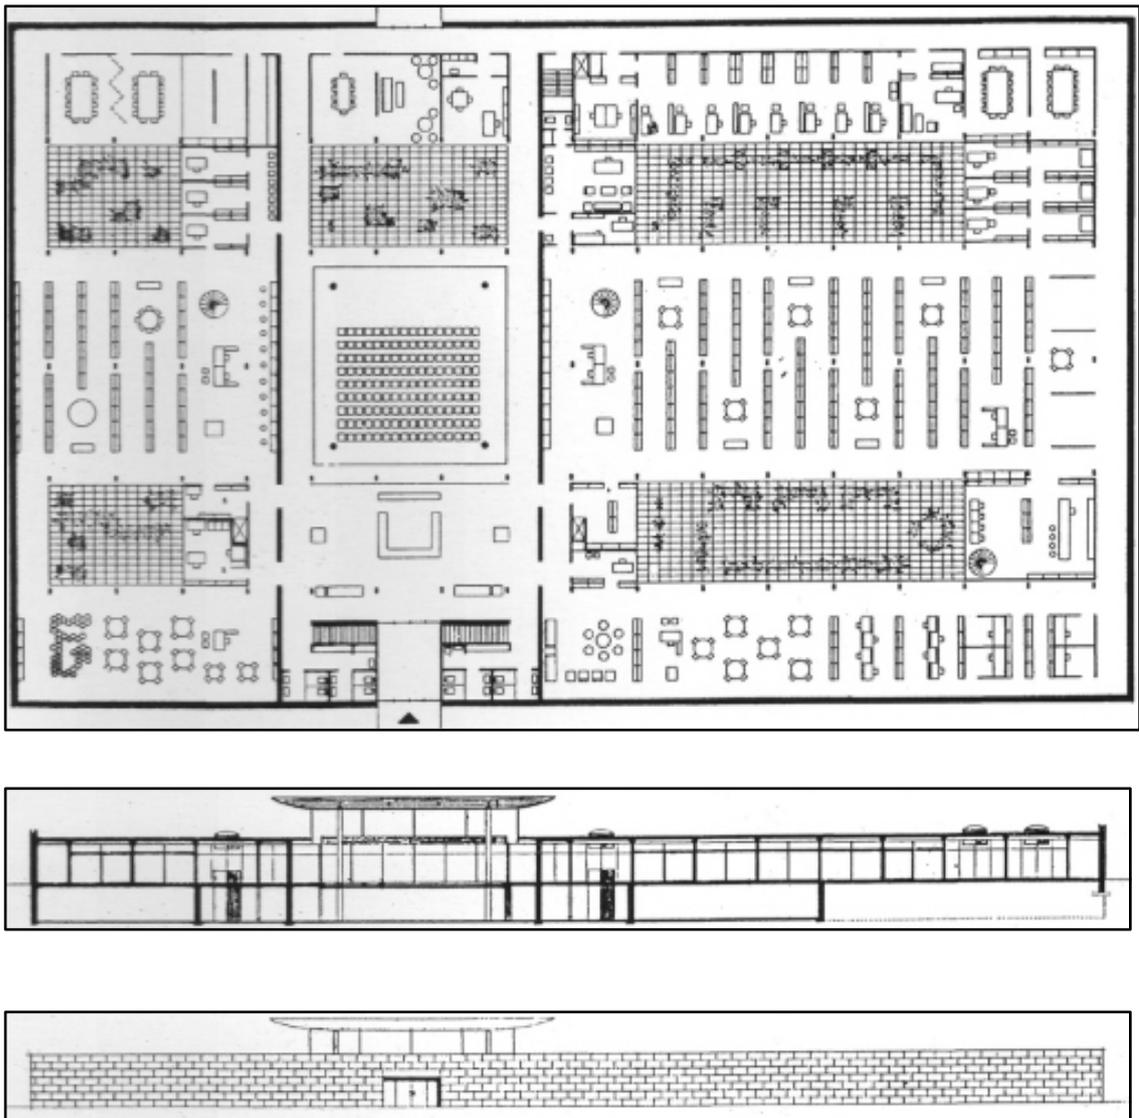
Corte; Alçado; Planta da biblioteca de Rødovre
